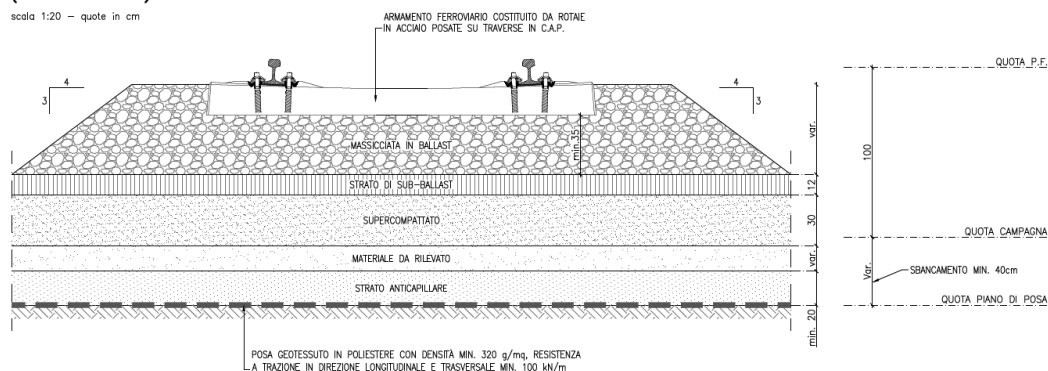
Estratto della tavola Sezioni Tipologiche: Pacchetto di pavimentazione per l'asta di raccordo
